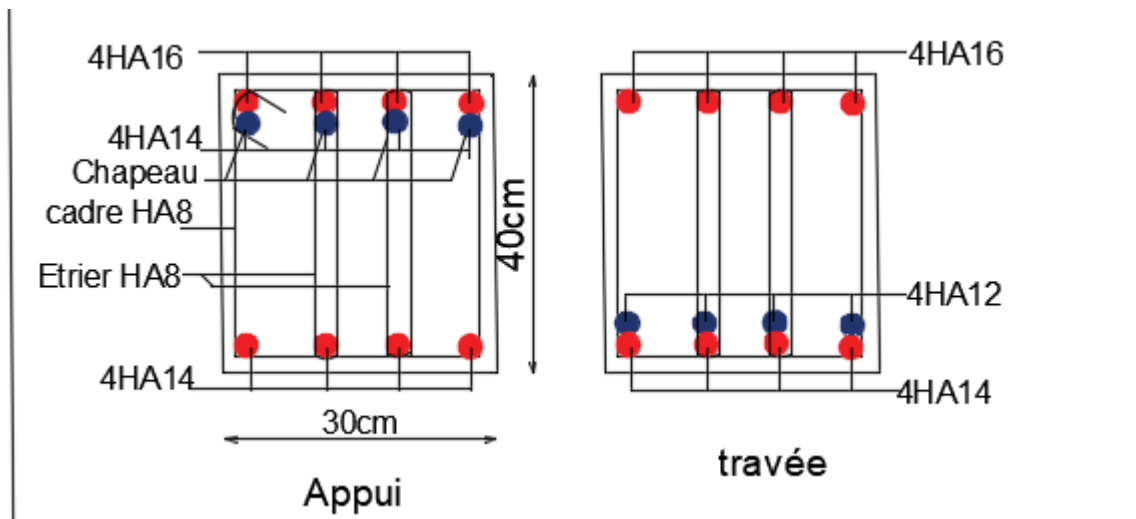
Schéma de ferrailage de la poutre principale du plancher RDC
